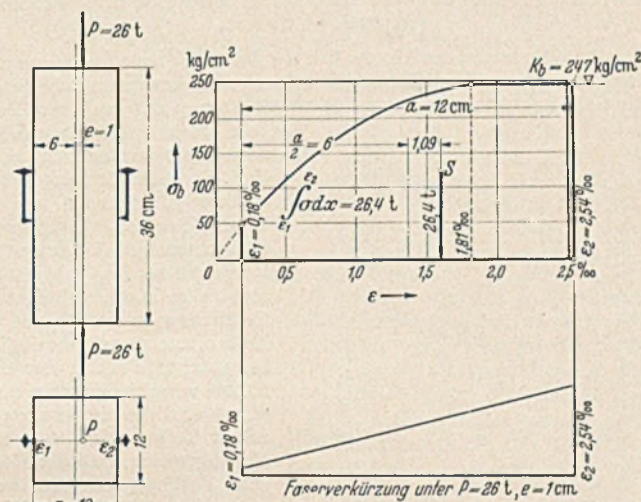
Spannungsverteilung in einem ausmittig gedrückten Betonprisma (nach Baumann).
